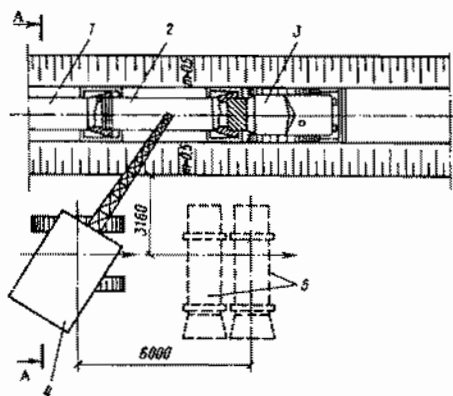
Монтаж железобетонных труб диаметром 1000 - 1200 мм с помощью бульдозера: 1,2 - уложенная и укладываемая трубы; 3 - бульдозер Д-159Б; 4 - монтажный кран (Э-652Б); 5 - раскладка труб
